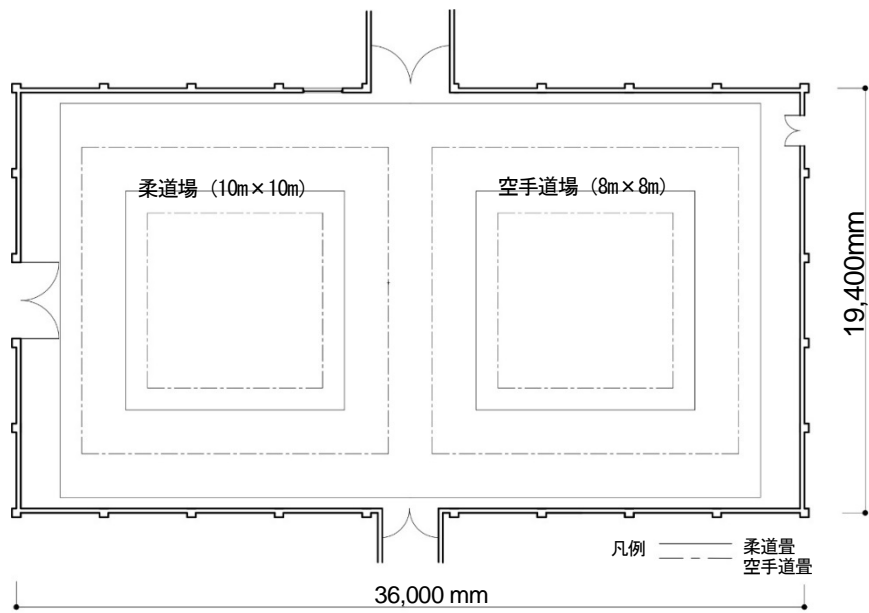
アリーナ平面図 1 (柔道場・空手道場レイアウト図)
